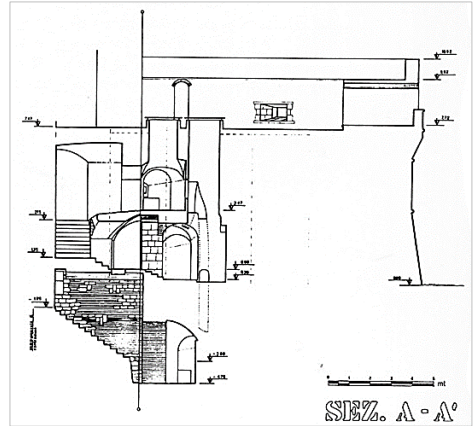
Puntone Santa Maria Maddalena: rilievo-progetto: sezione A-A’ (Archivio Taddei, 1997).
